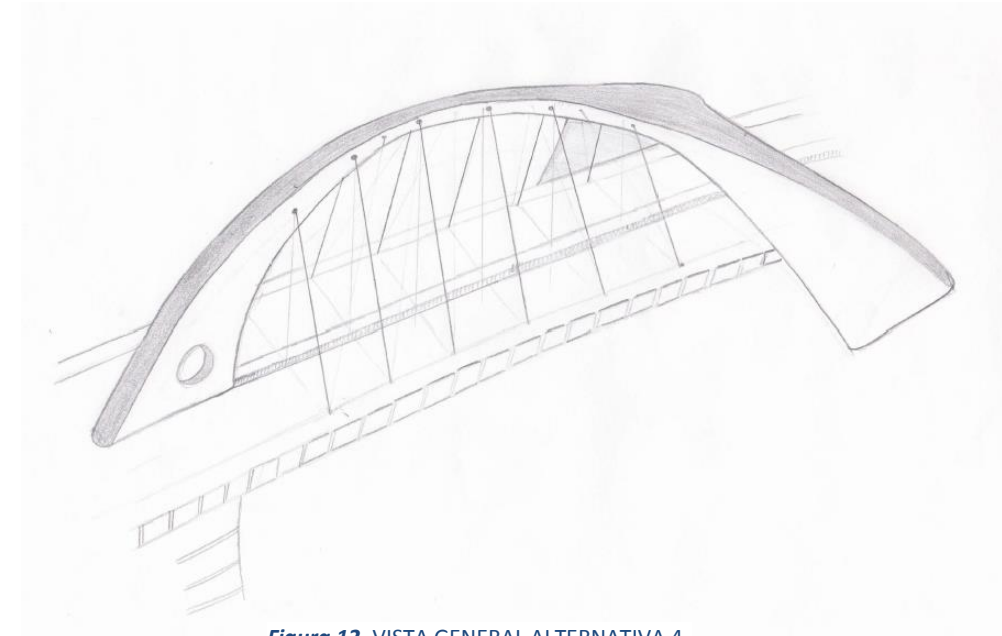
VISTA GENERAL ALTERNATIVA 4.
